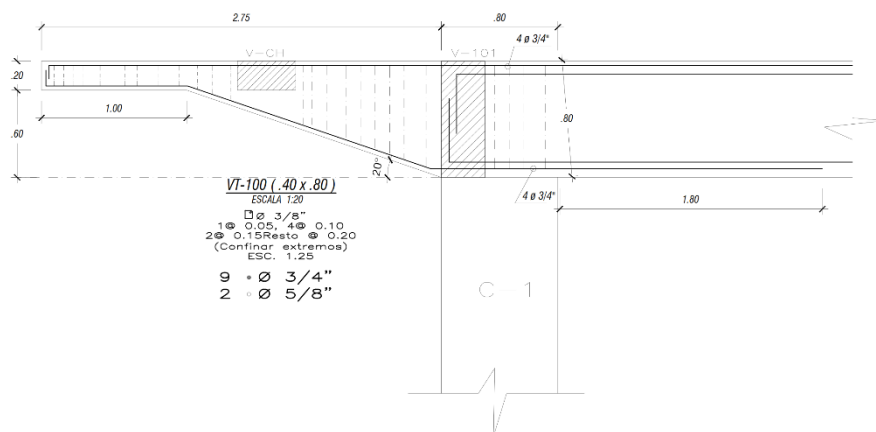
Detalle de ménsula que soporta los voladizos en la Fachada.
